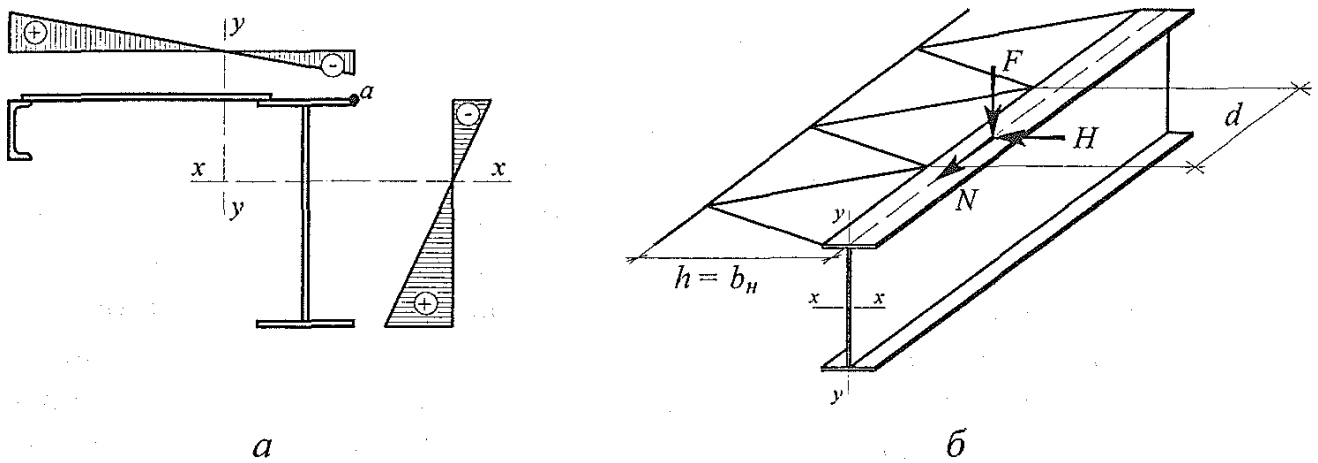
Розрахункові схеми підкранових балок з гальмівними балкою (а) і фермою (б)
